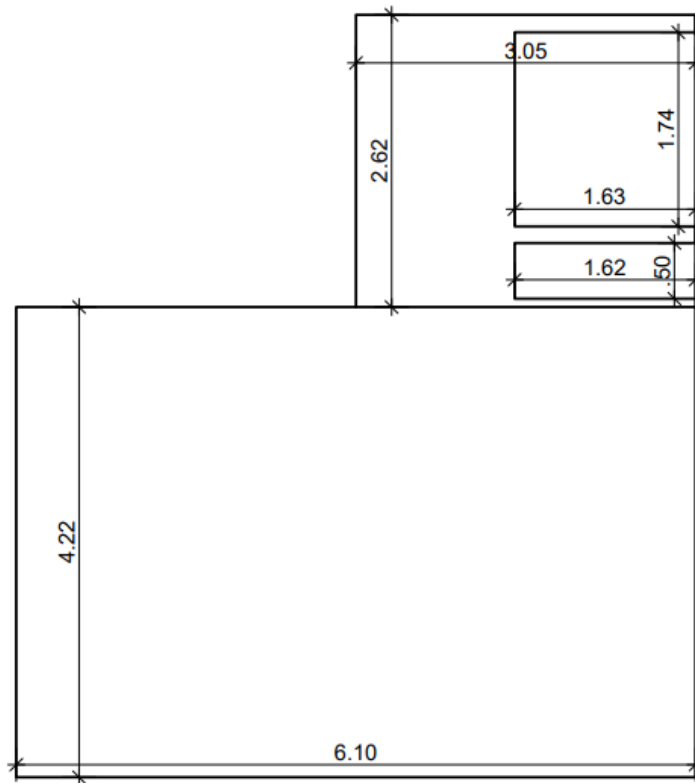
Medidas da recepção para os cálculos das áreas do pavimento térreo.
